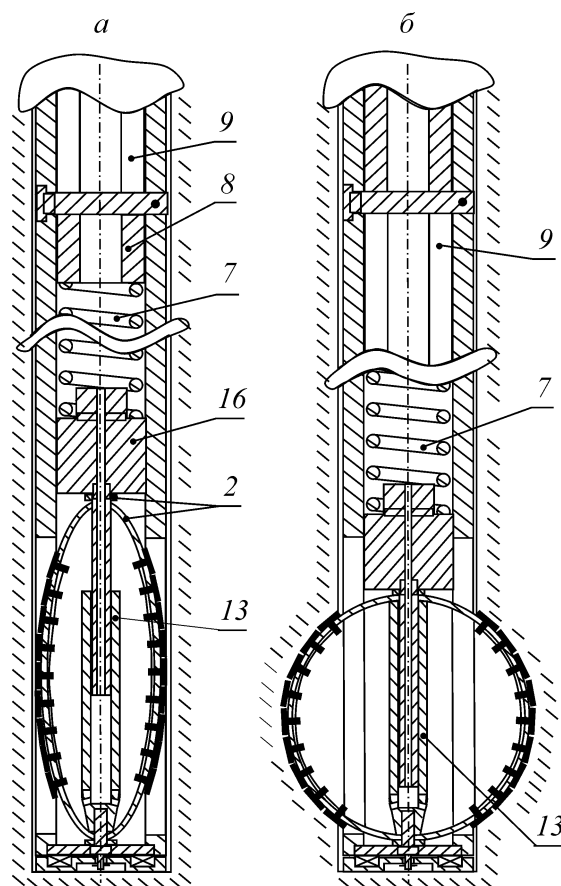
Образователь шаровых полостей с ограничением усилий на рабочих органах: *a* — в исходном положении; *б* — в момент окончания формирования полости; 2 — упругие пластины; 7 — пружина; 8 — труба; 9 — продольные прорезы; 13 — стакан; 16 — втулка
